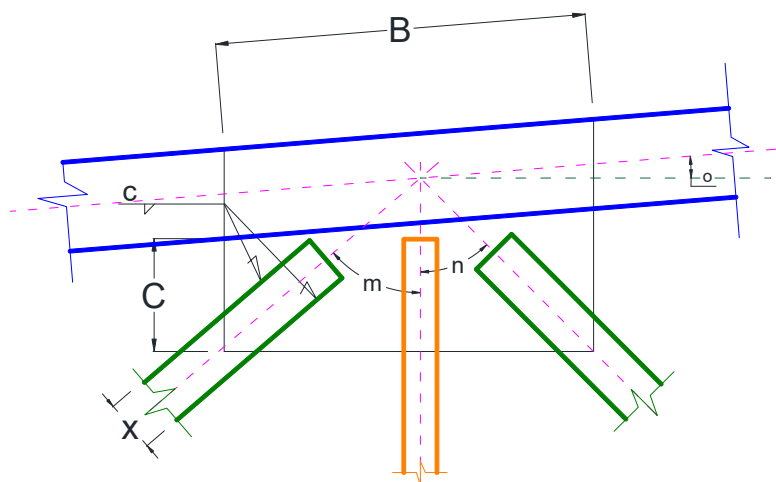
Diagrama de Soldadura en Diagonal izquierda
